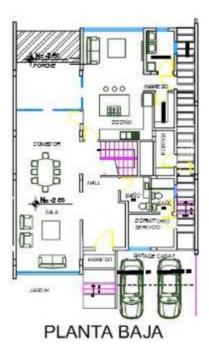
Casa 7 - planta baja Elaborado por: Carolina Calupiña M
